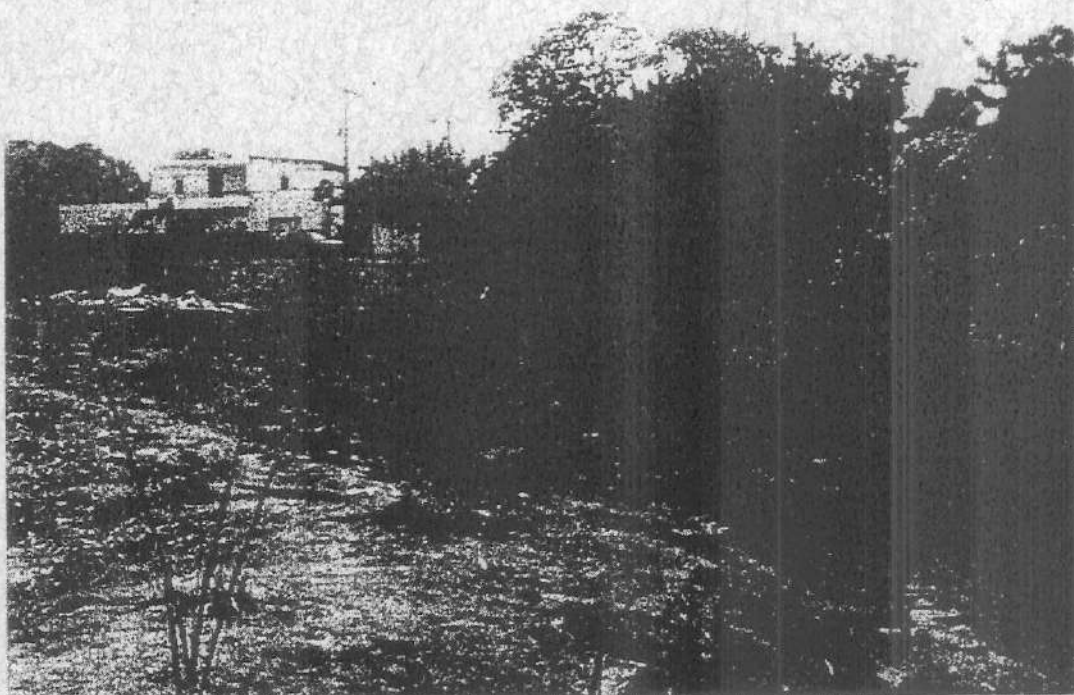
Trecho final das obras iniciadas sem licenciamento, cruzamento da Av. João XXIII.
